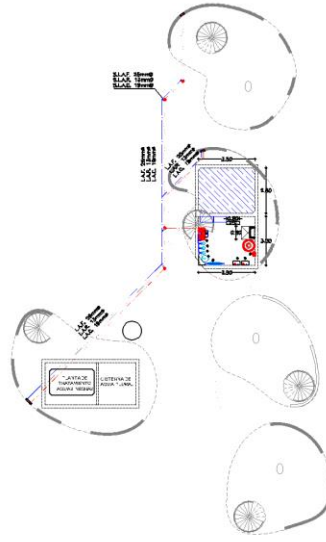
Ubicación de sistemas y líneas de instalaciones hidráulicas en planta baja.
